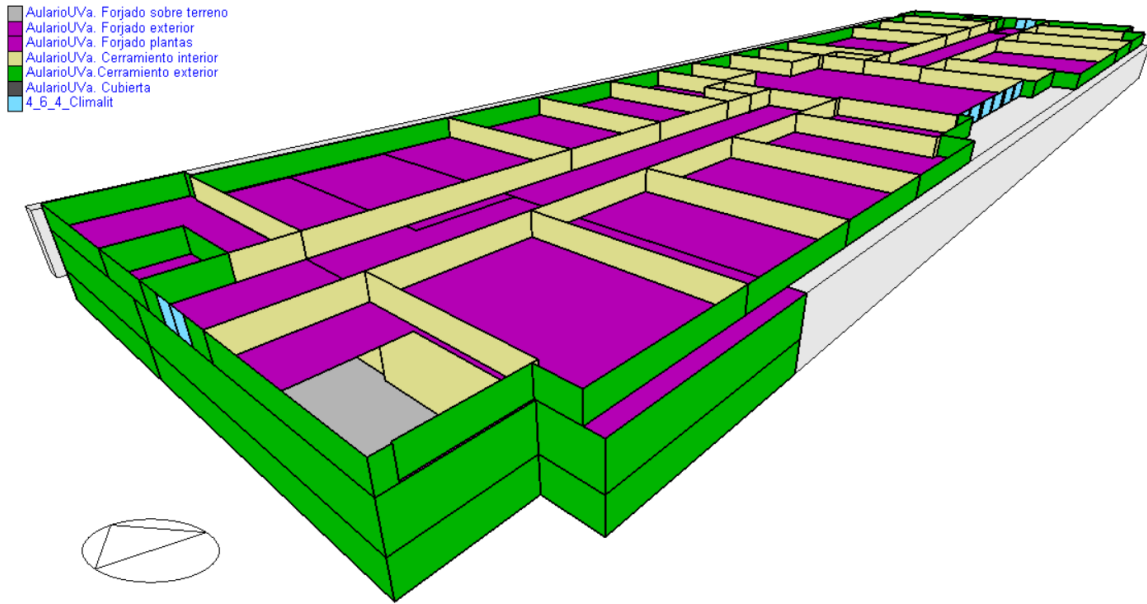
Vista en sección en un plano paralelo a la planta del edificio (identificando tipología de cerramiento)
